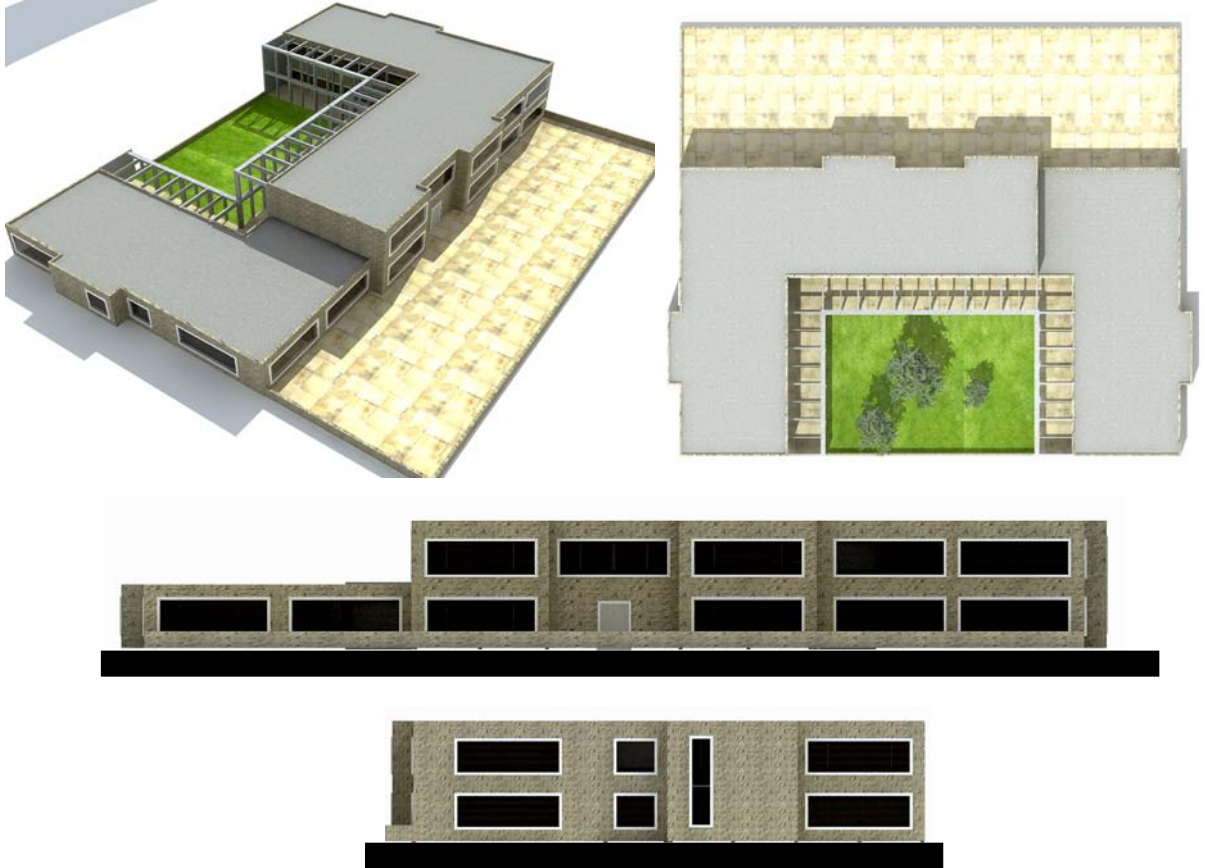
Üç derslikli ilköğretim okulu plan şeması
